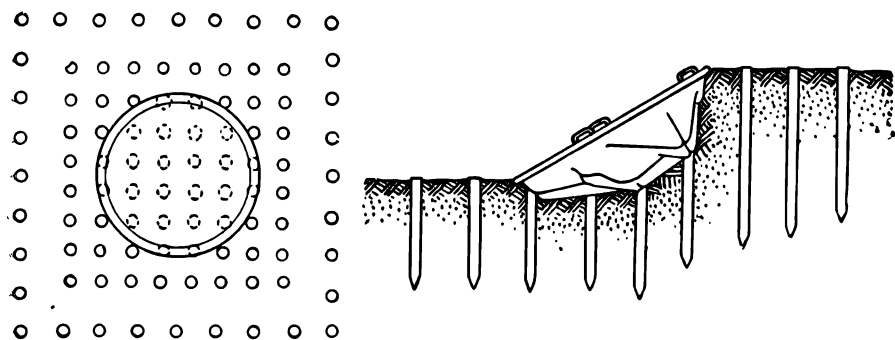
Укрепление грунта под опорную плиту забивкой кольев
